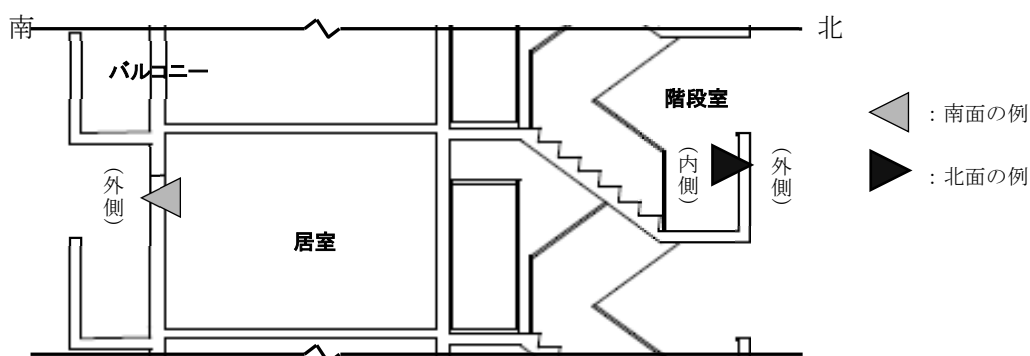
コア採取位置の例 (南北方向断面図)
